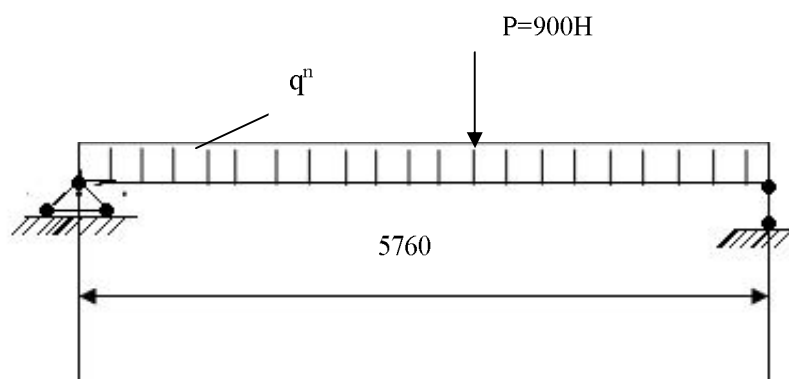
Расчетная схема косоуров при проверке на зыбкость.
